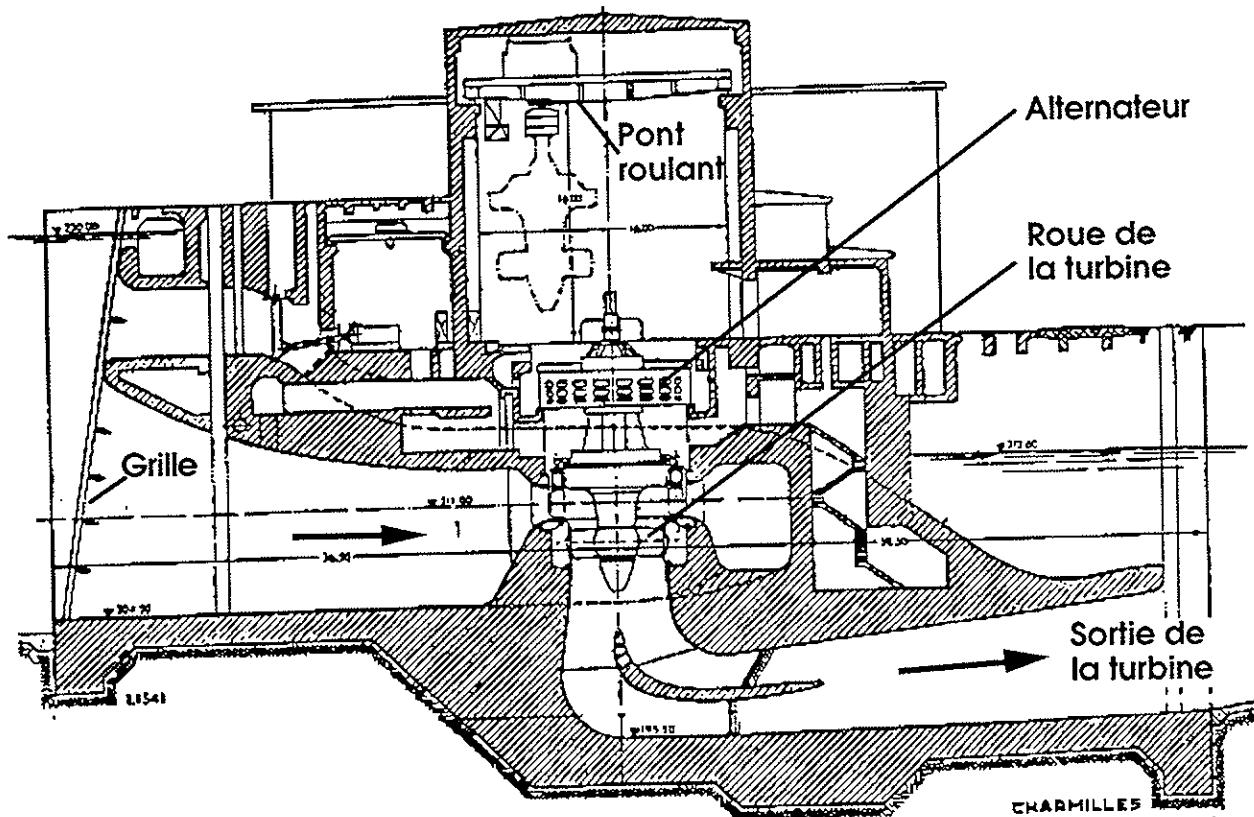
Centrale basse chute au fil de l'eau
